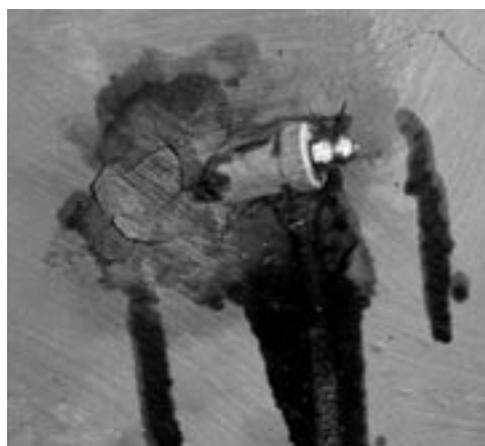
Eingebohrte Verpressdüse für Injektion zur Betoninstandsetzung
